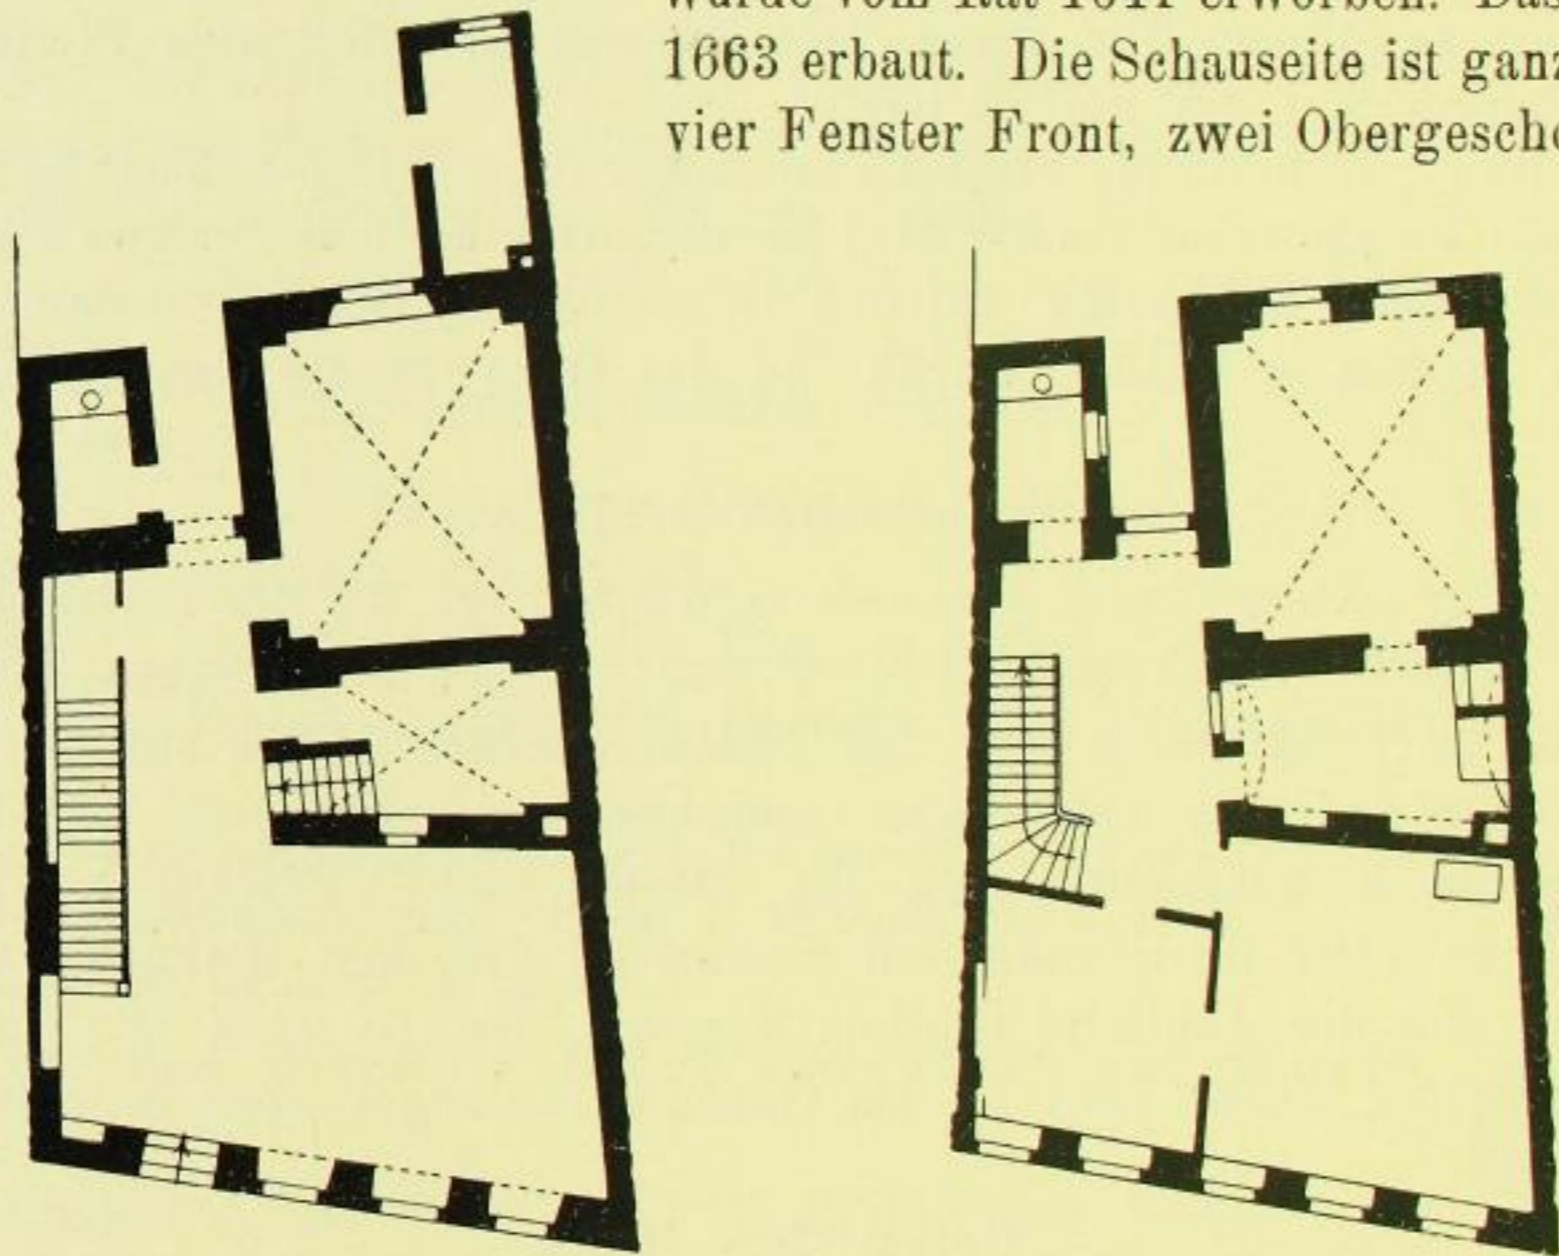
und 190. Sekundariat, Grundriß vom Erdgeschoß und I Obergeschoß.
